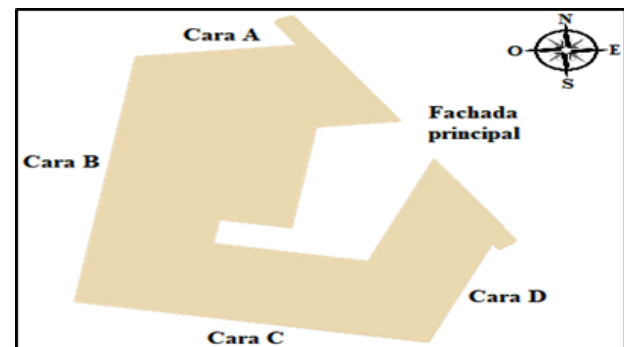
b) Distribución de fachadas exteriores del Baluarte Santa Rosa
